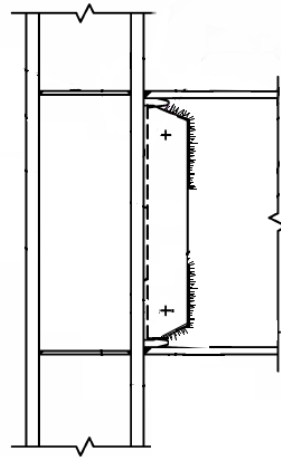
Assemblage de poutres où les ailes sont soudées à l'aile du poteau et où l'âme est soudée à un gousset soudé sur l'aile du poteau ; les boulons servent en phase de montage.
